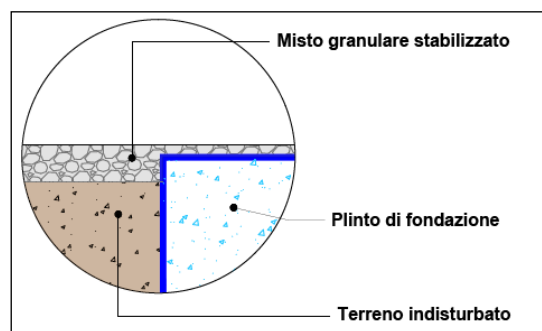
Particolare pavimentazione piazzola tipo in fase di esecuzione lavori
